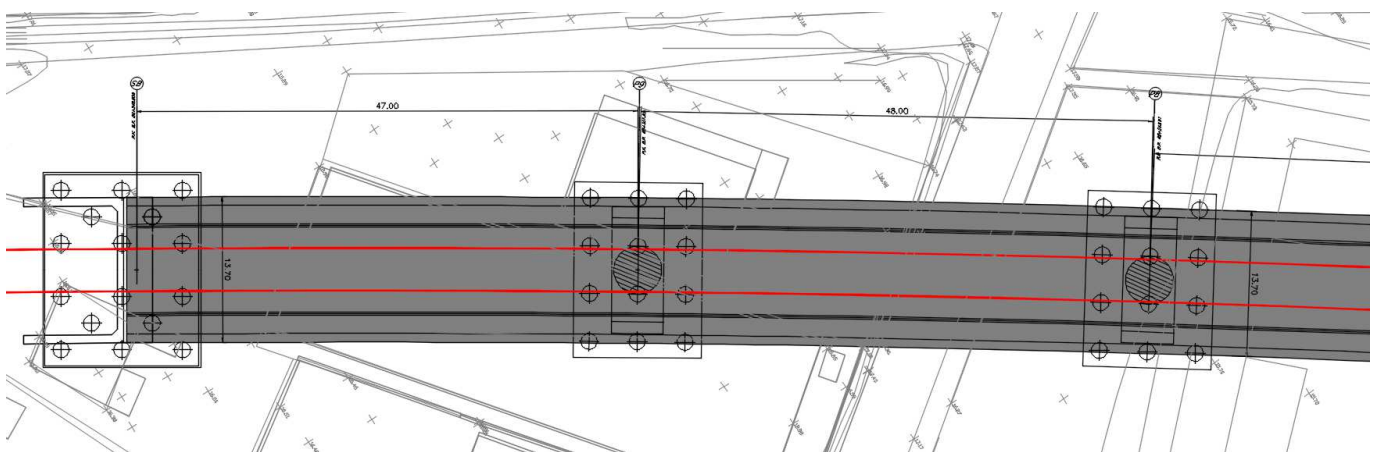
planimetria generale tra spalla B e Pila 8
